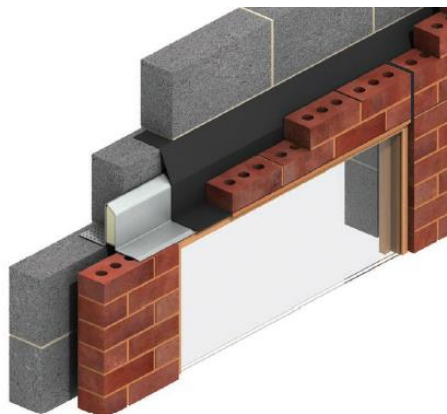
1 – Pormenor da zona da padieira (adaptado de (Ancon, 2016))
